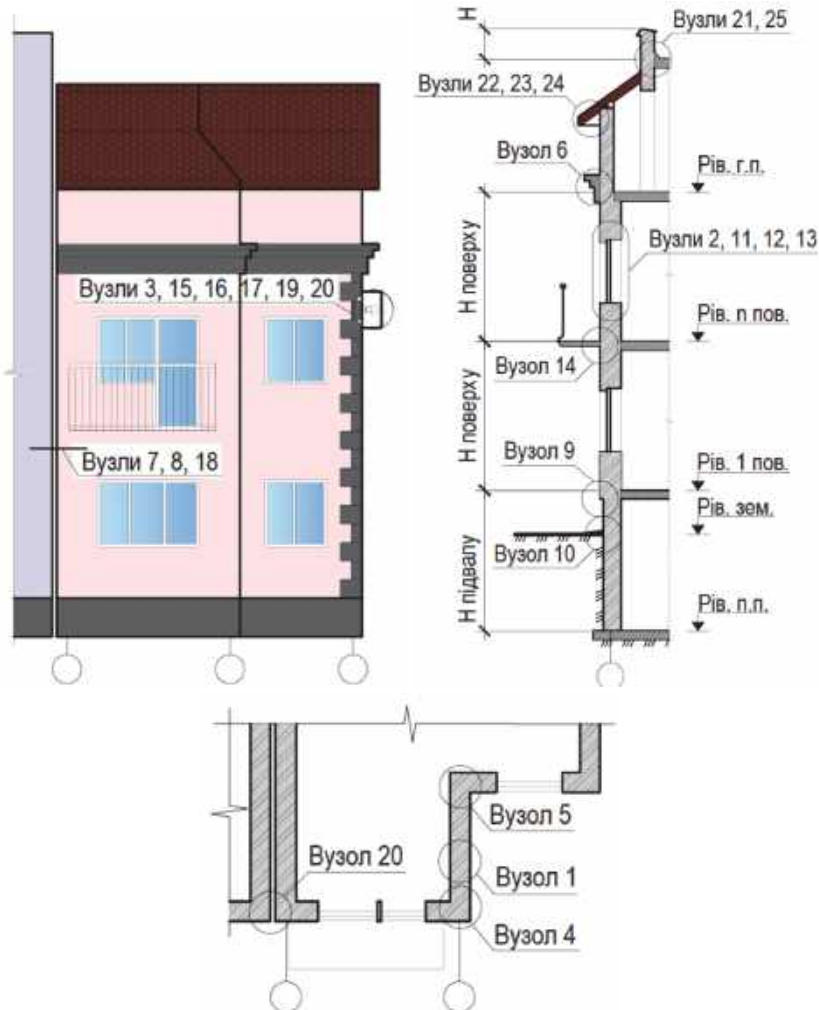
Фрагменти креслень із прив'язкою вузлів теплової ізоляції фасаду будівлі
